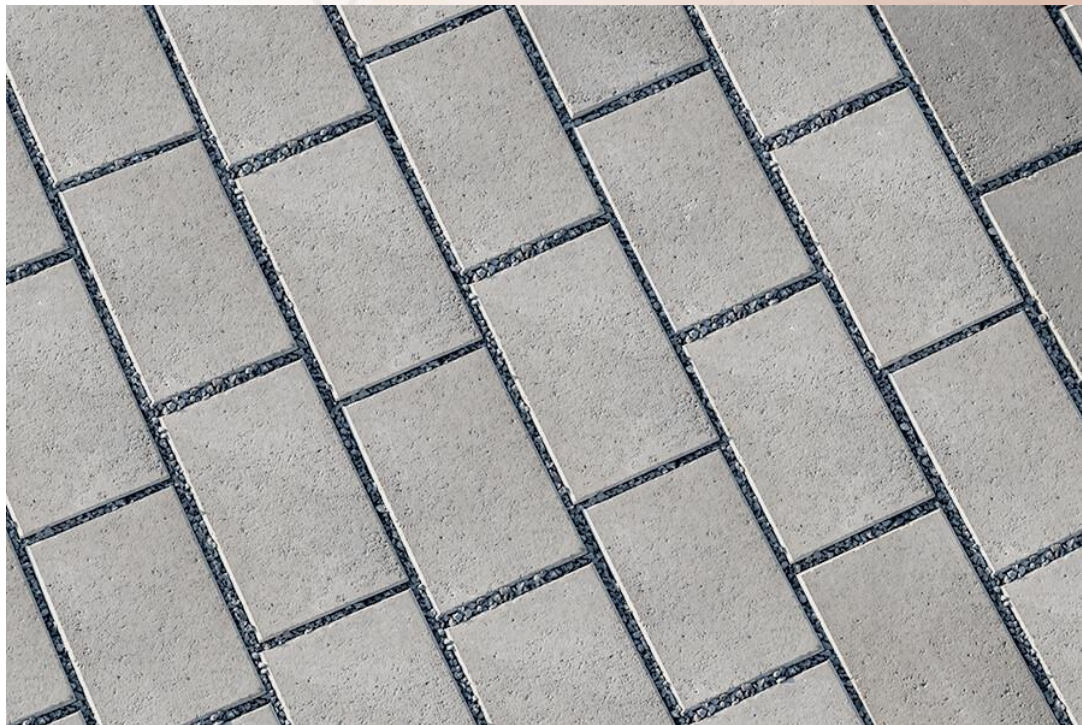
FIGURE: RECONSTRUCTION DE LA CHAUSSÉE
